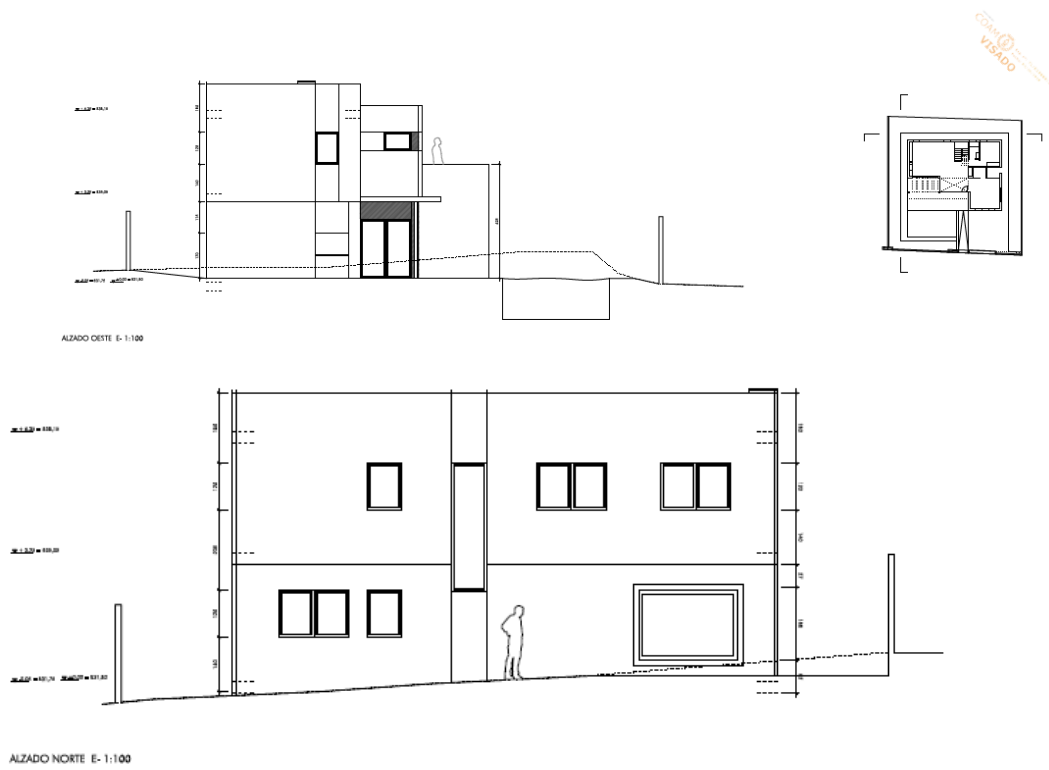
Sección de arquitectura 3. Fuente: Arhotek
